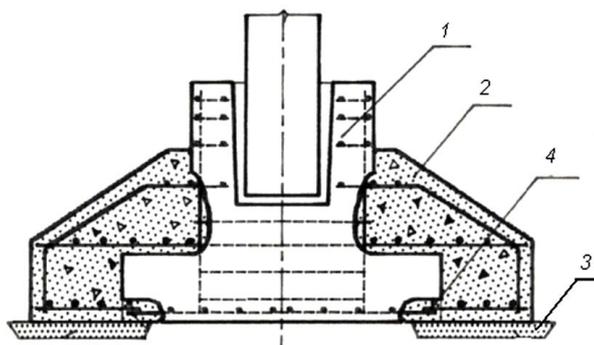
Уширение подошвы фундамента под колонну: 1 – существующий фундамент; 2 – наращивание части фундамента; 3 – щебеночно-песчаная подготовка; 4 – сварное соединение
